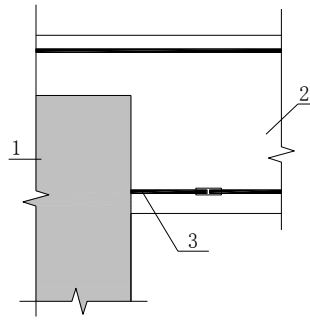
后浇连梁与预制剪力墙连接构造示意
